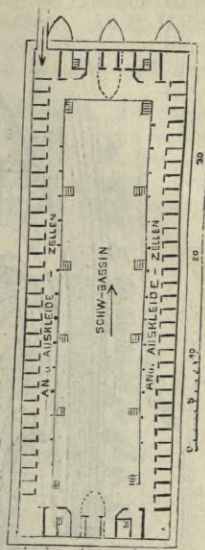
Grundriss des Herren-Badeschiffs.
